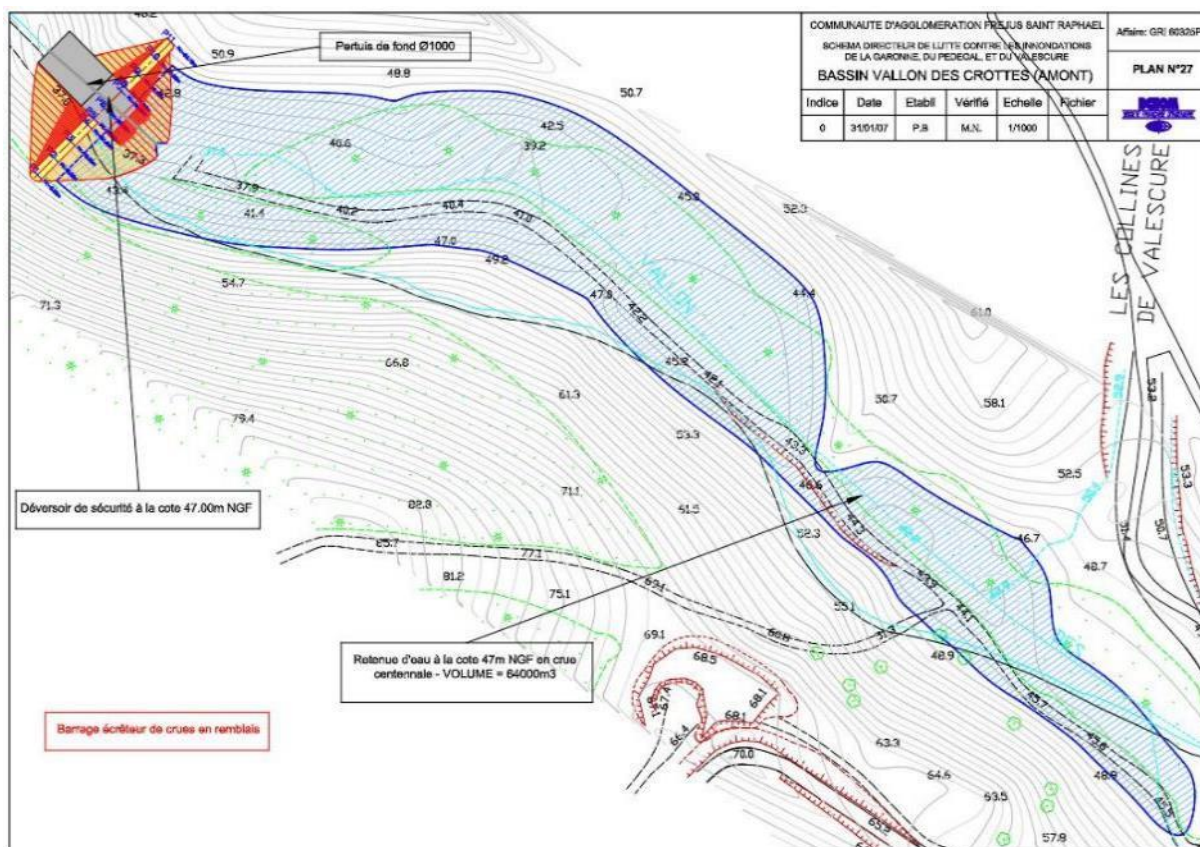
Plan du barrage des crottes (Source : CAVEM)
